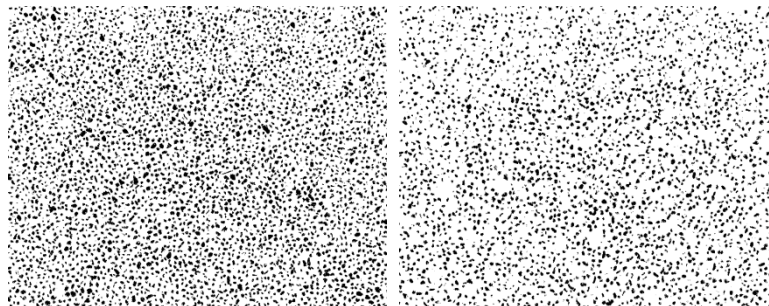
Schwarz-weiß Bild von gut (links) und schlecht (rechts) eingepressten Körnern
